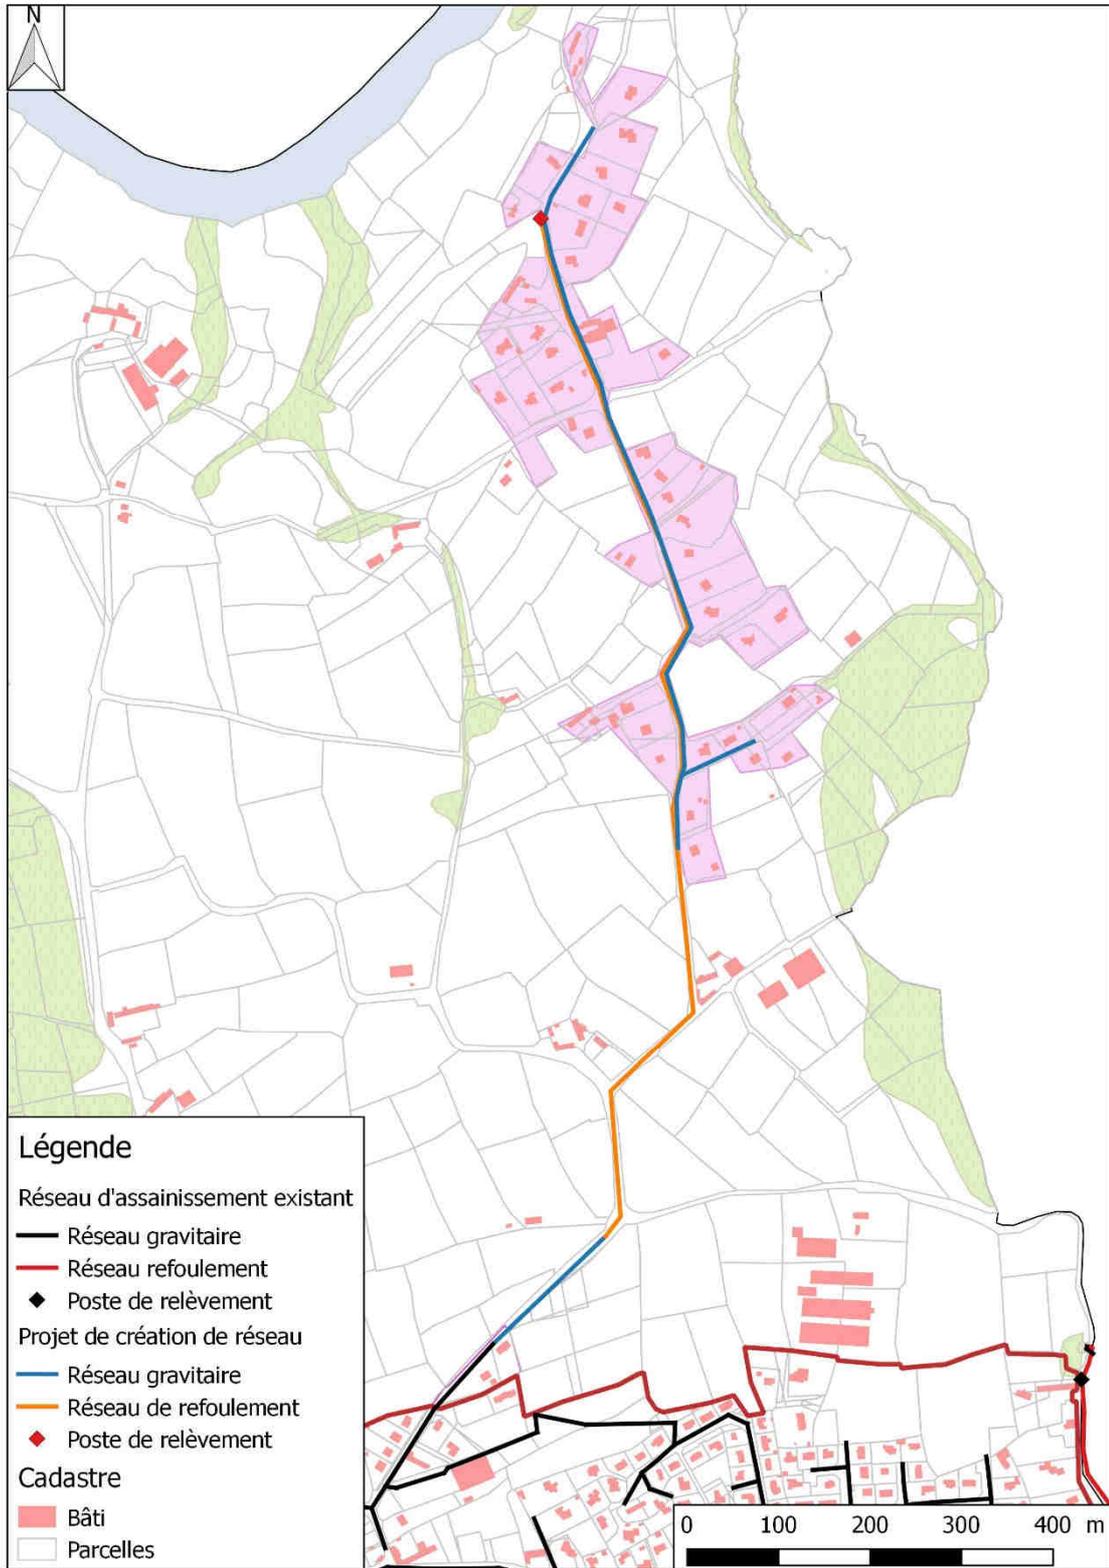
Projet de raccordement du secteur de Saint Lavan à la station de Kerbabu
